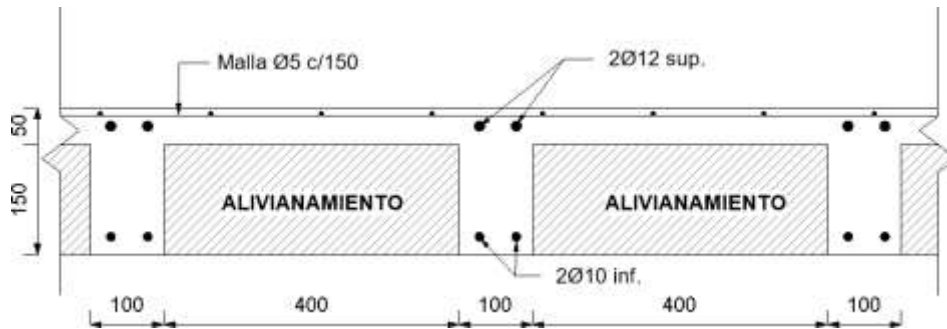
Sección transversal de losa aligerada. [Elaboración propia]
